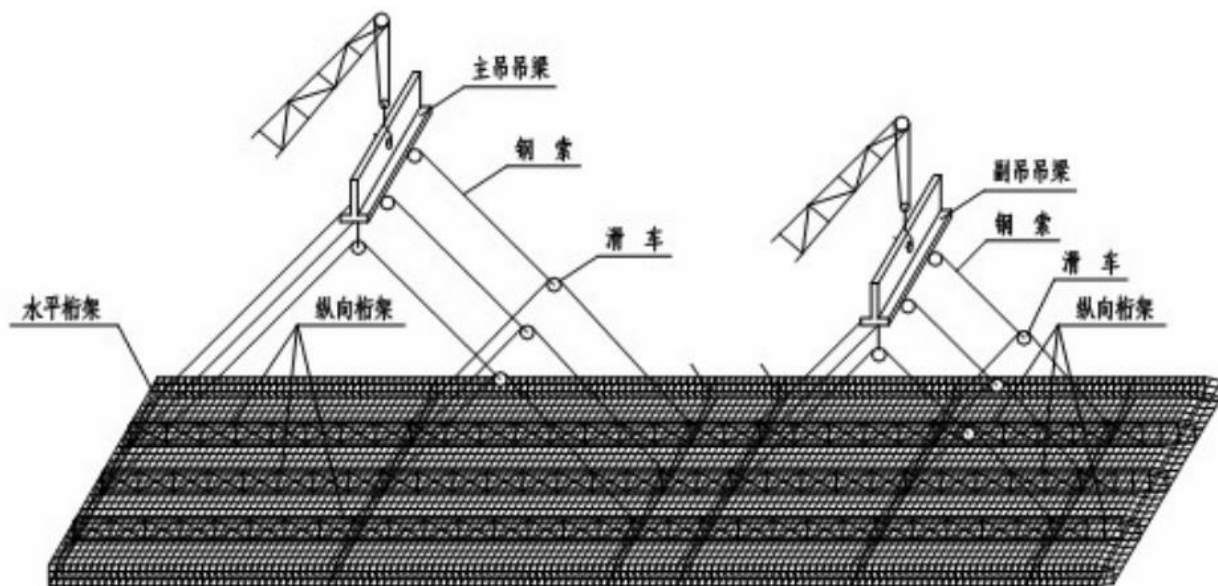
腾博大厦基坑支护及土石方工程 钢筋笼起吊示意图
